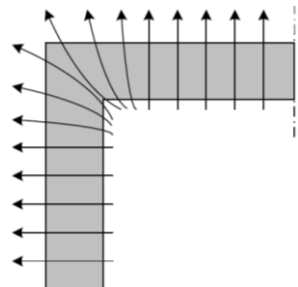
Ponte térmica no encontro entre paredes exteriores (cunhal) [Valério, 2007]
